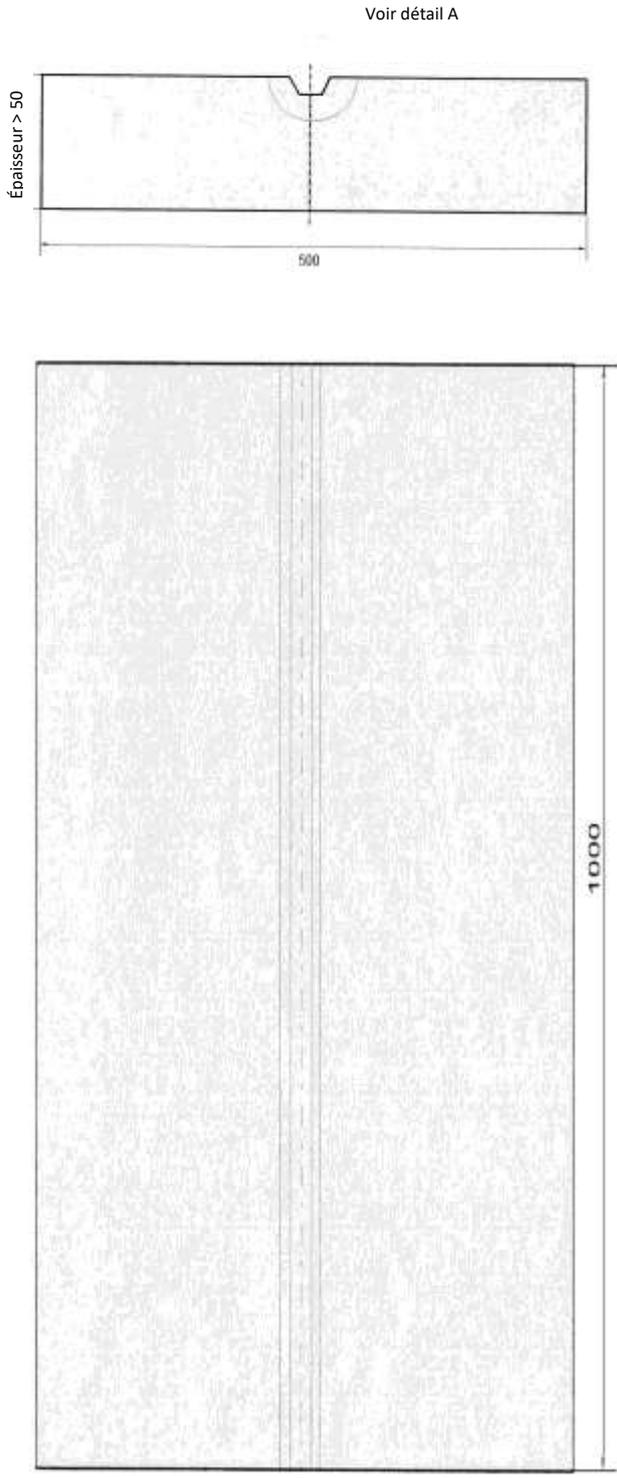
Sto-Panneaux pour Bossage Type II (dimensions en mm)
